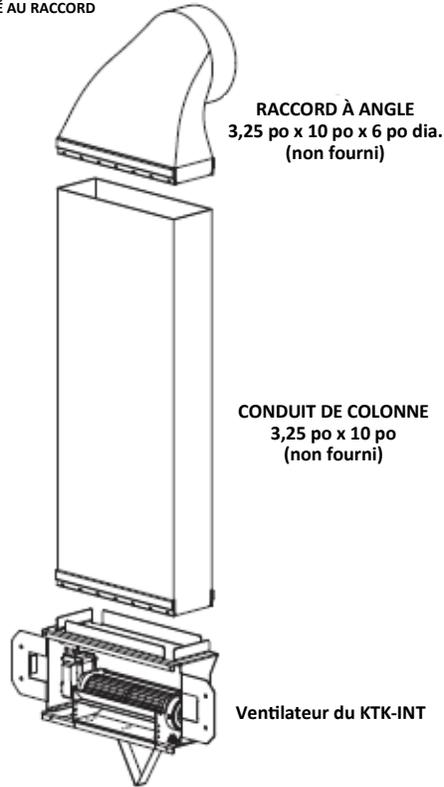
, HTK-INT avec conduit de colonne (option d'installation)
